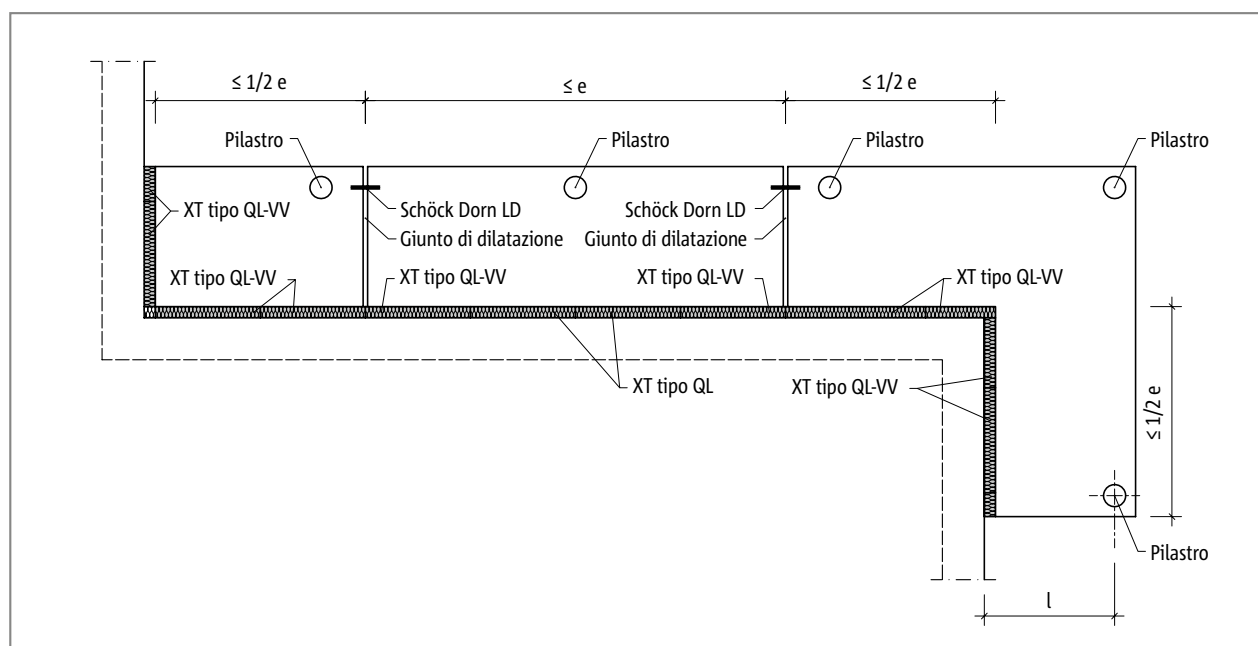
Schöck Isokorb® XT tipo QL, QL-VV: disposizione dei giunti di dilatazione
